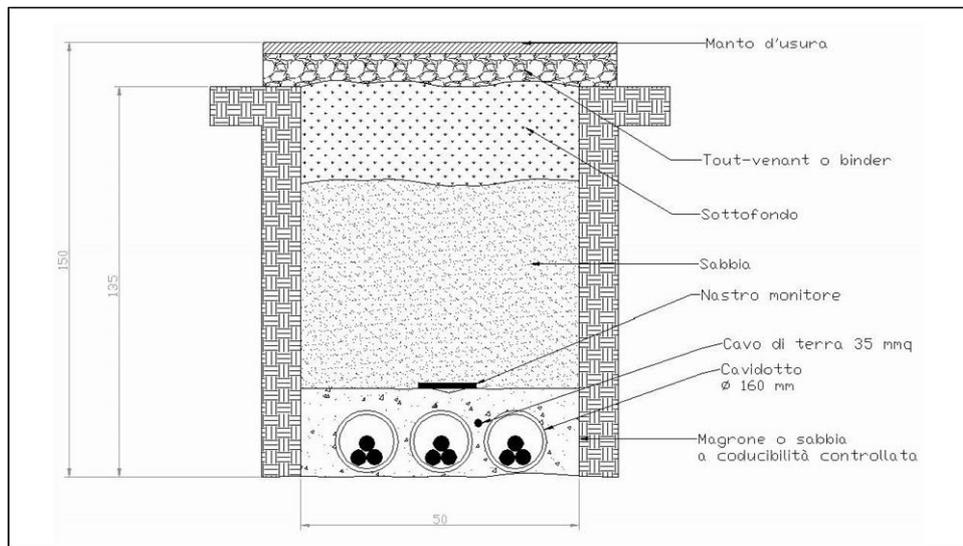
Sezione tipo di posa con n° 3 terne di cavi
